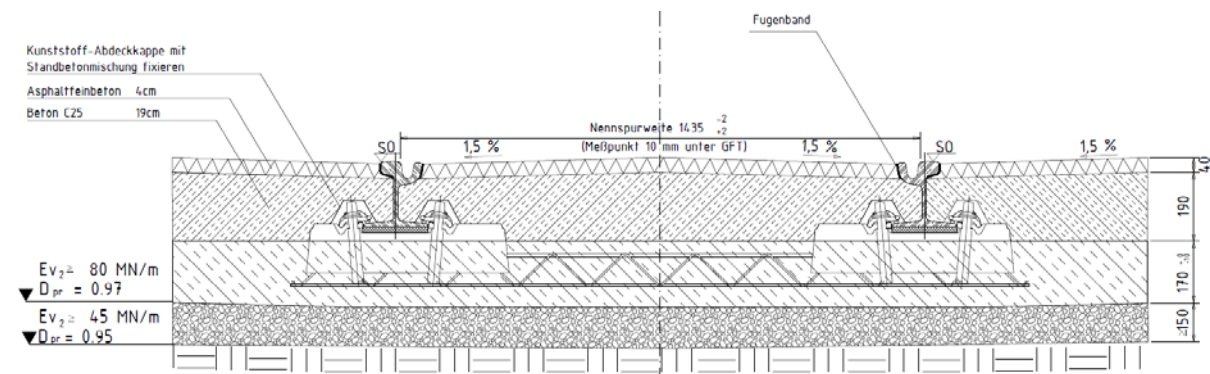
Oberbau Abstellhalle (Bau 1, BT 1)
